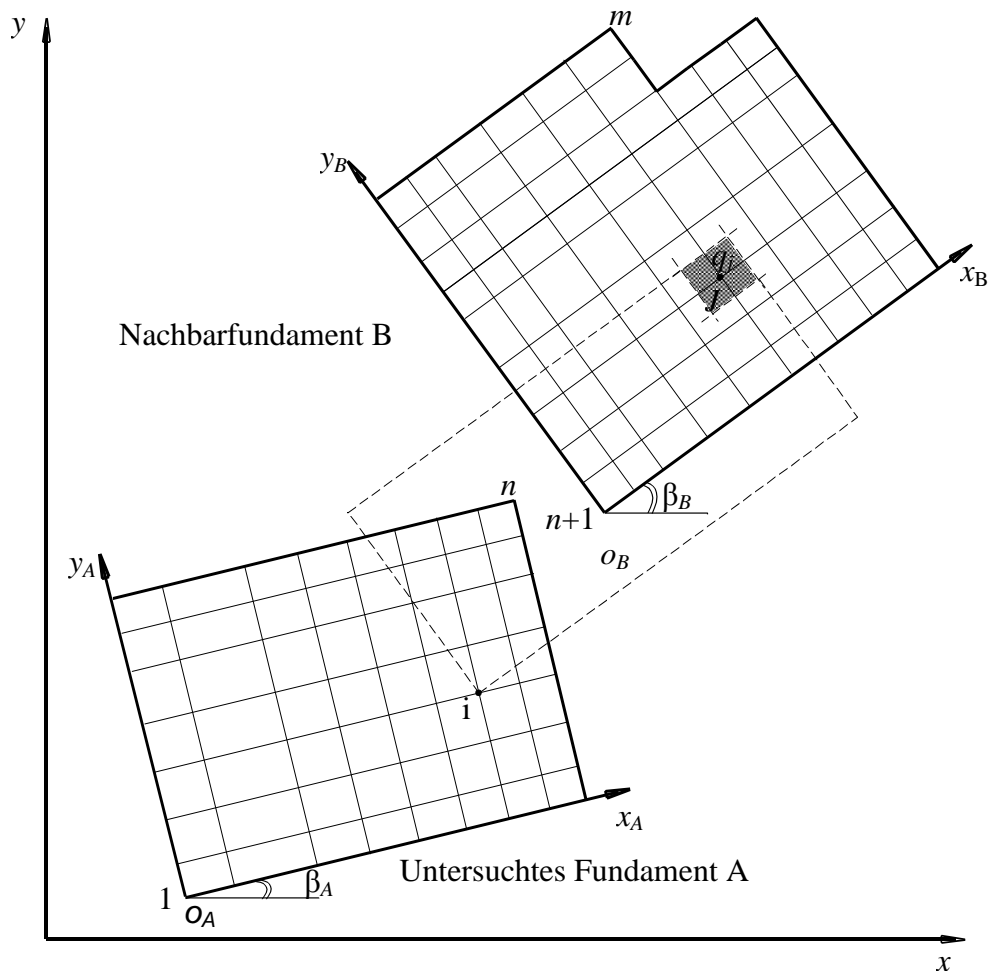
Grundriss des zu untersuchenden Fundaments mit Nachbarfundament
